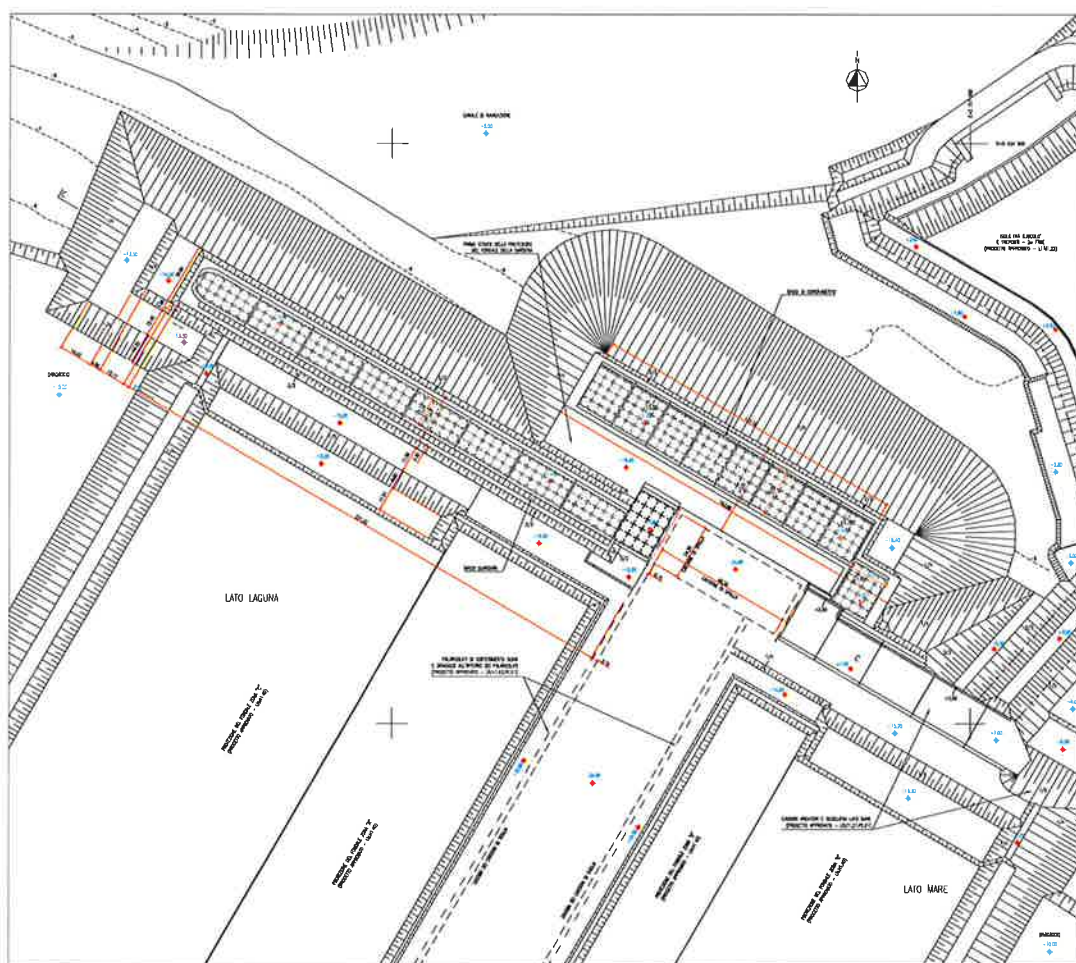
SPALLA NORD, PLANIMETRIA DELLE OPERE DELLA SECONDA WBE DELLA SPALLA NORD
